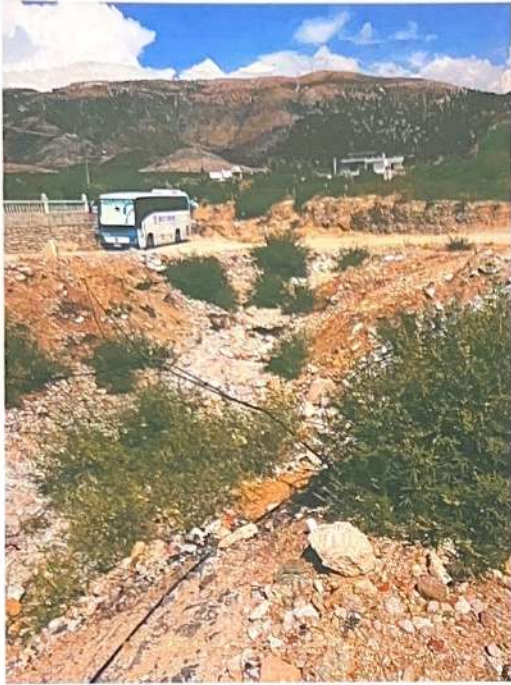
FOTO TE BANESAVE DHE PROIT TE KORAMIT MBI LAGJEN POTAM
